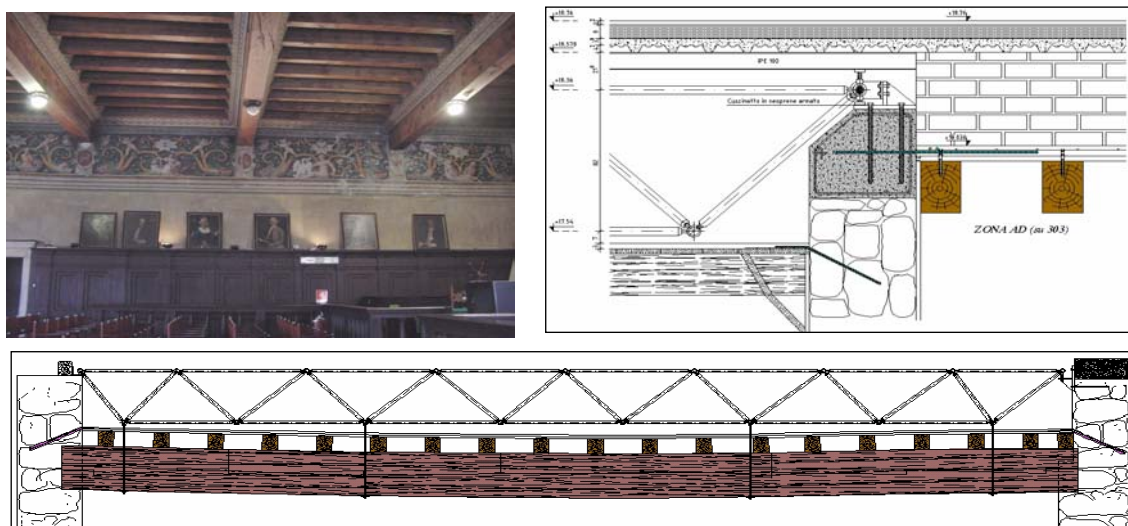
a, b, c. La struttura reticolare spaziale al di sopra del solaio
